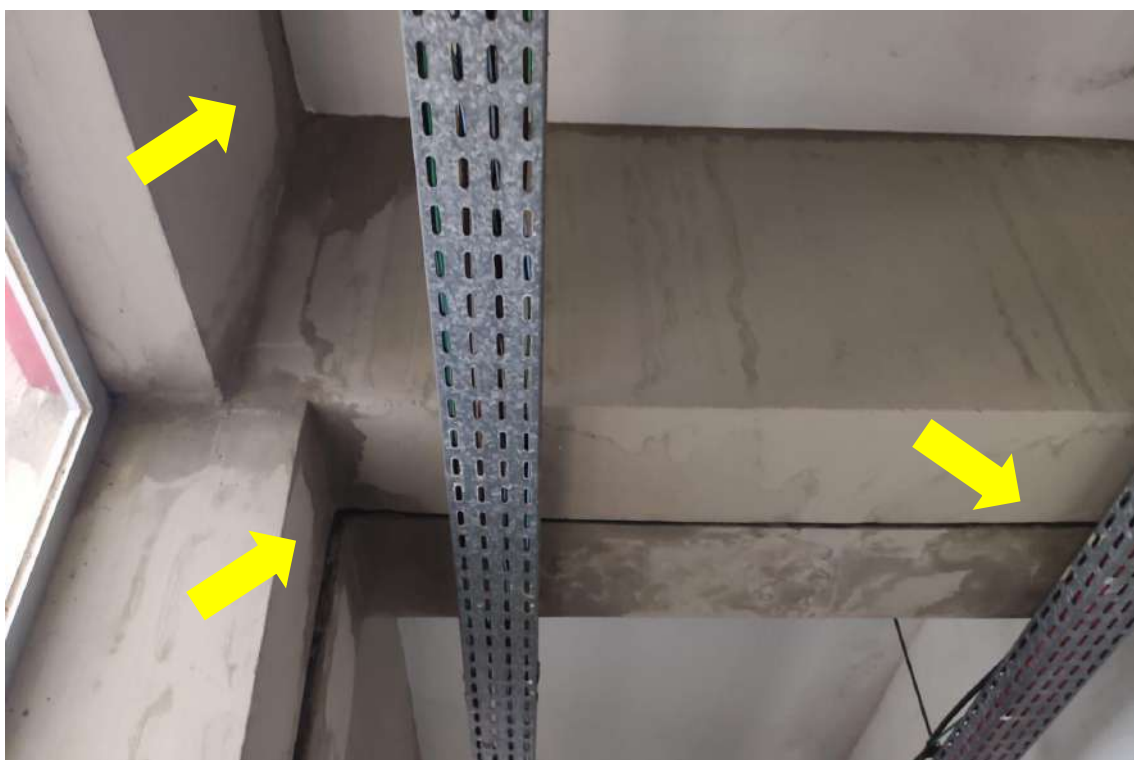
Infiltração no teto no Prédio da Reitoria (DCF - PROPLAN térreo)
